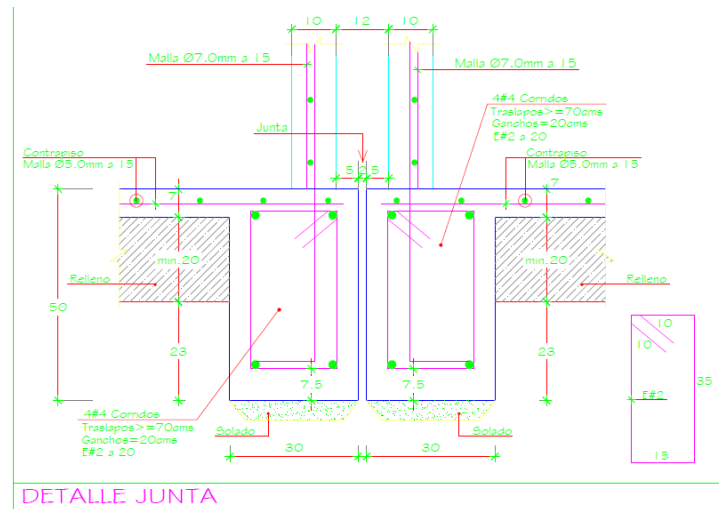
Refuerzo de acero en la cimentación para una junta
